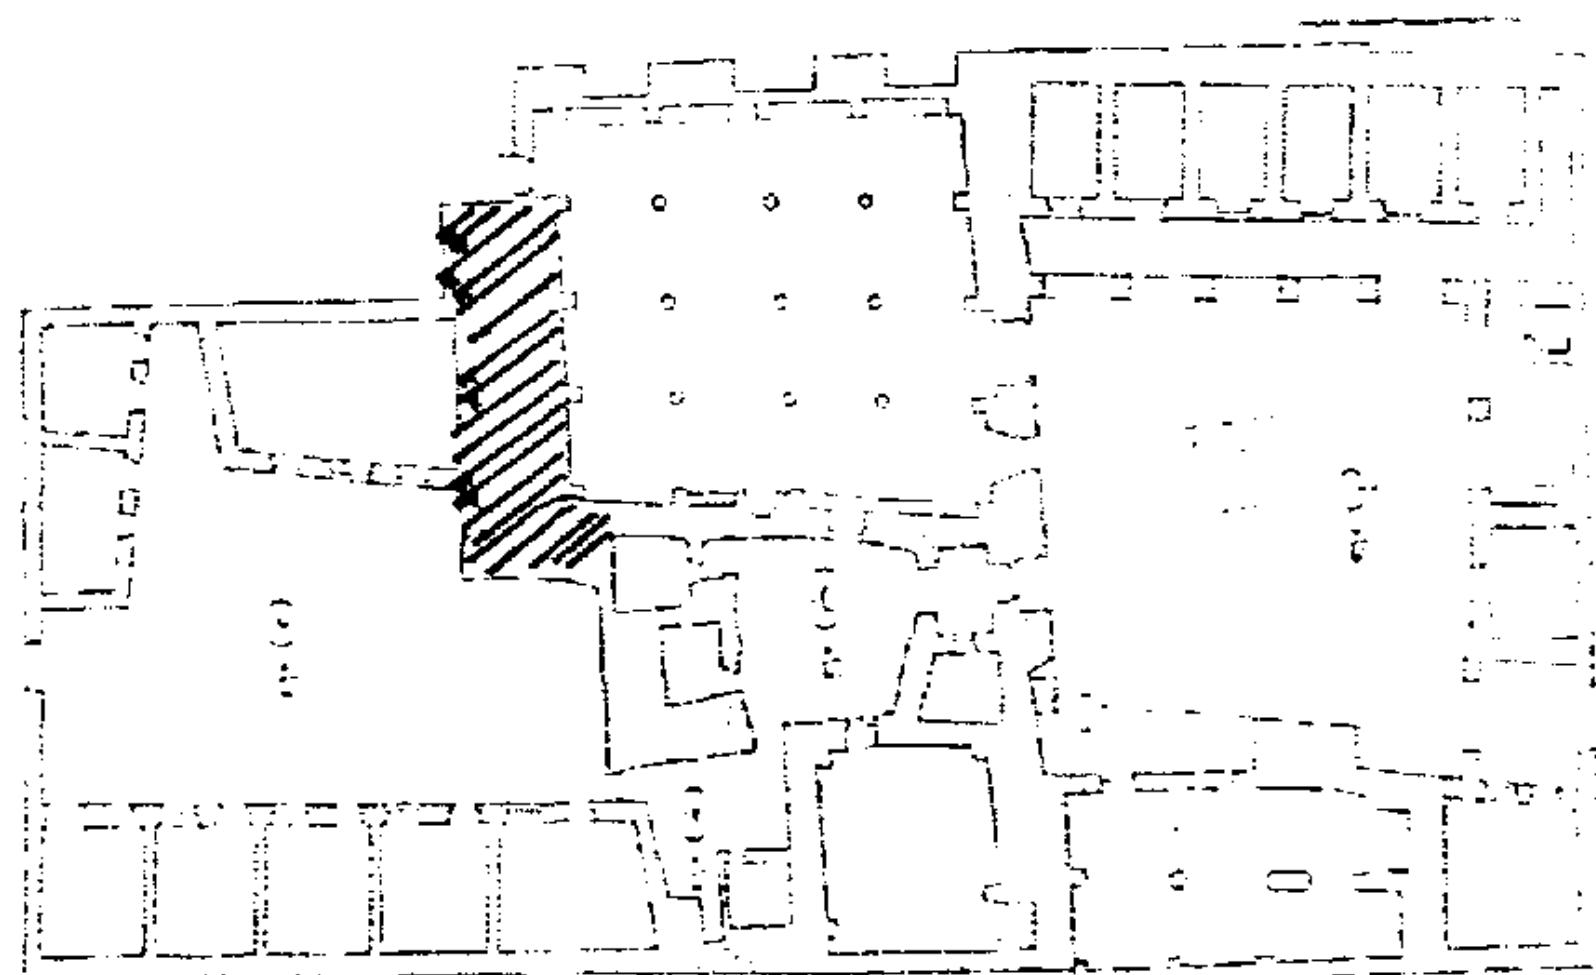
مسقط أفقى لجامع محمود عن الموسوعة (الجزء الأول).
